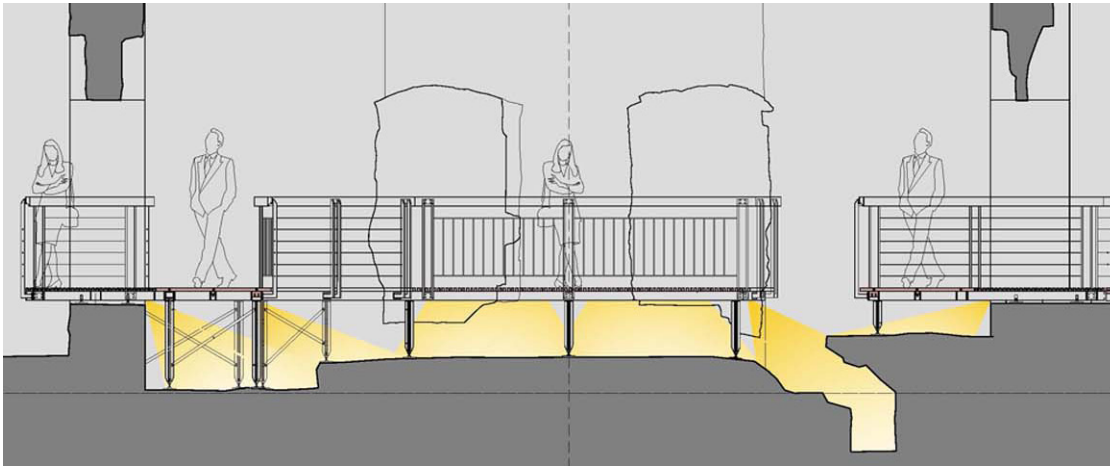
Sala Ottagona con l'inserimento della passerella ponte con attraversamento centrale che si appoggia sulle testate delle murature perimetrali.
